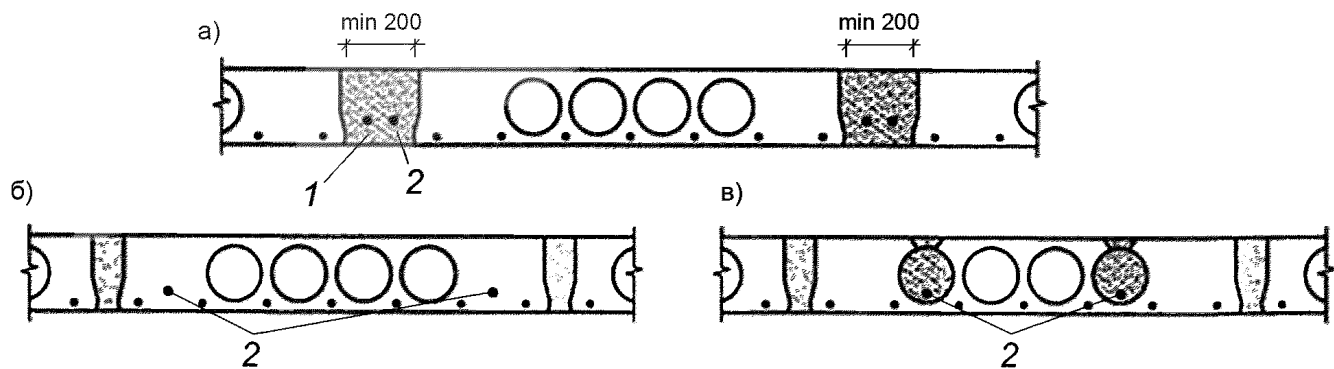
Варианты соединения плит перекрытия с ригелями (а) и между собой (б)
